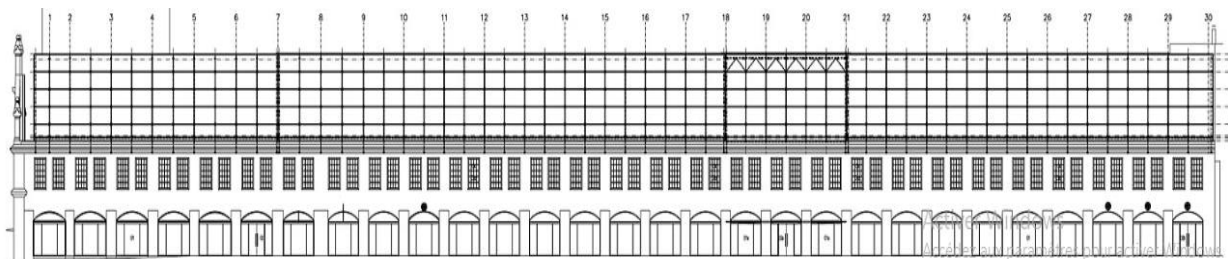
, 91, 92 : ANALYSE DE LA FAÇADE SOURCE : DOCUMENT ARCHITECTE RICARDO BOFILL
